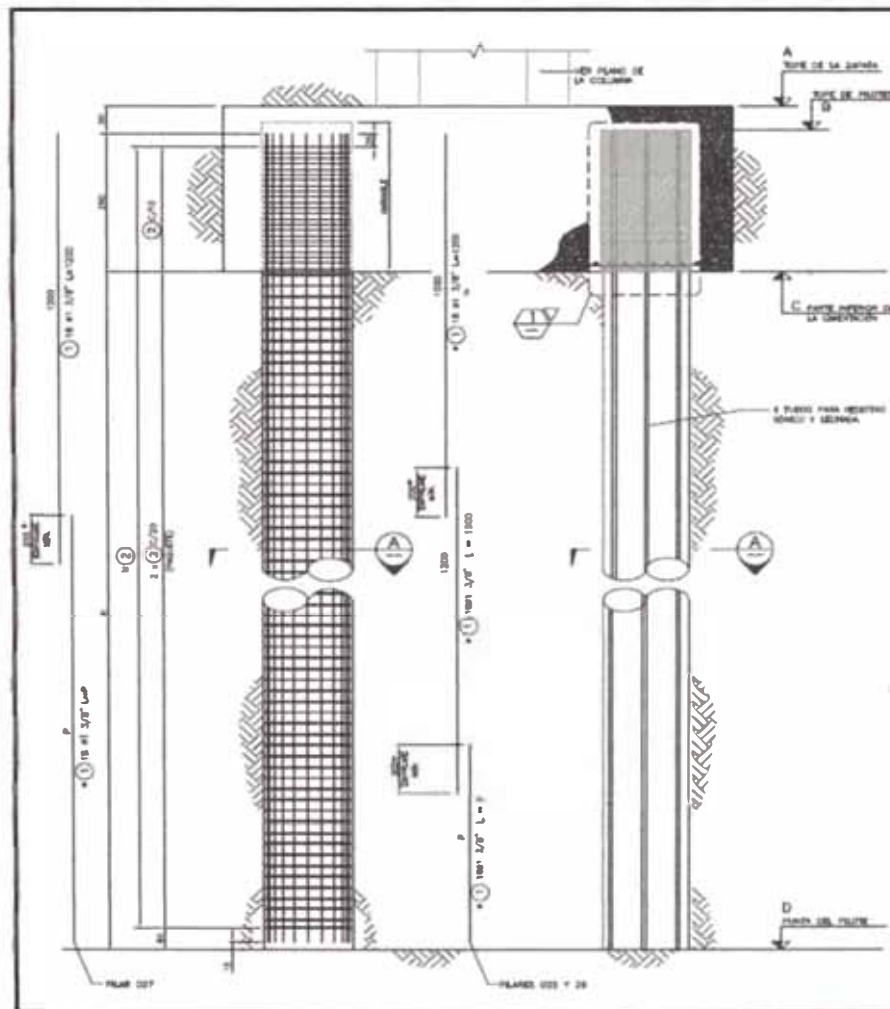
Acero de Refuerzo Típico – Pilotes
